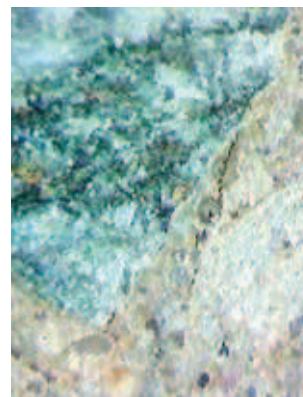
Przemrożony beton ścian fundamentowych wielokondygnacyjnego budynku mieszkalnego
